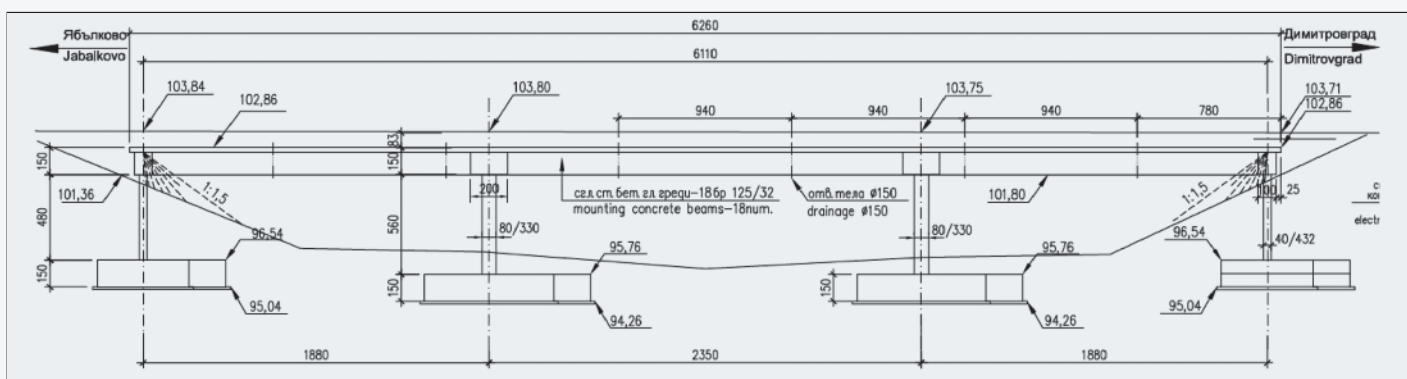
Il prospetto dell'opera, sezione longitudinale
